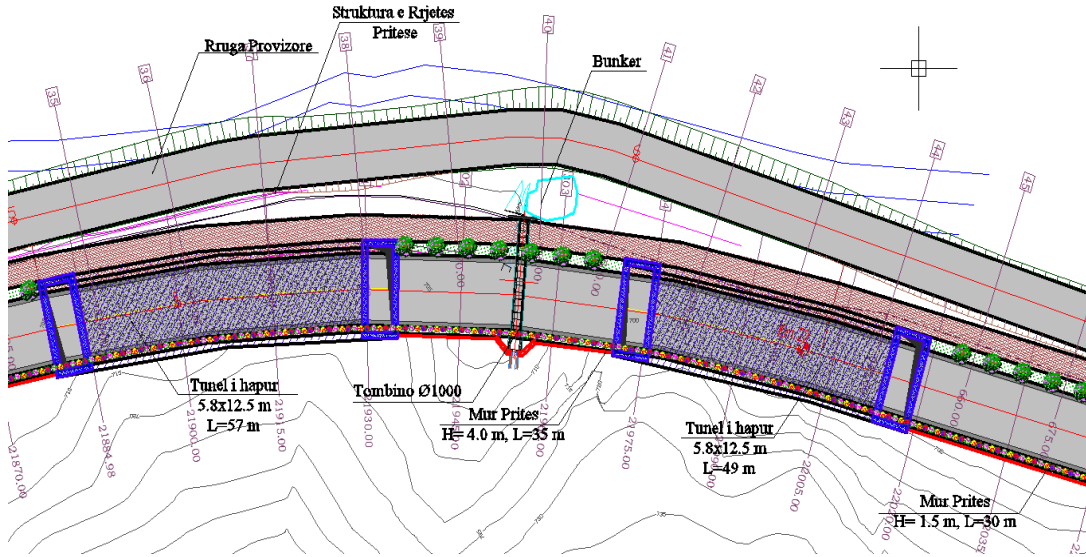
Fragment planimetrie i rruges provizore ne zonen e bunkerave
